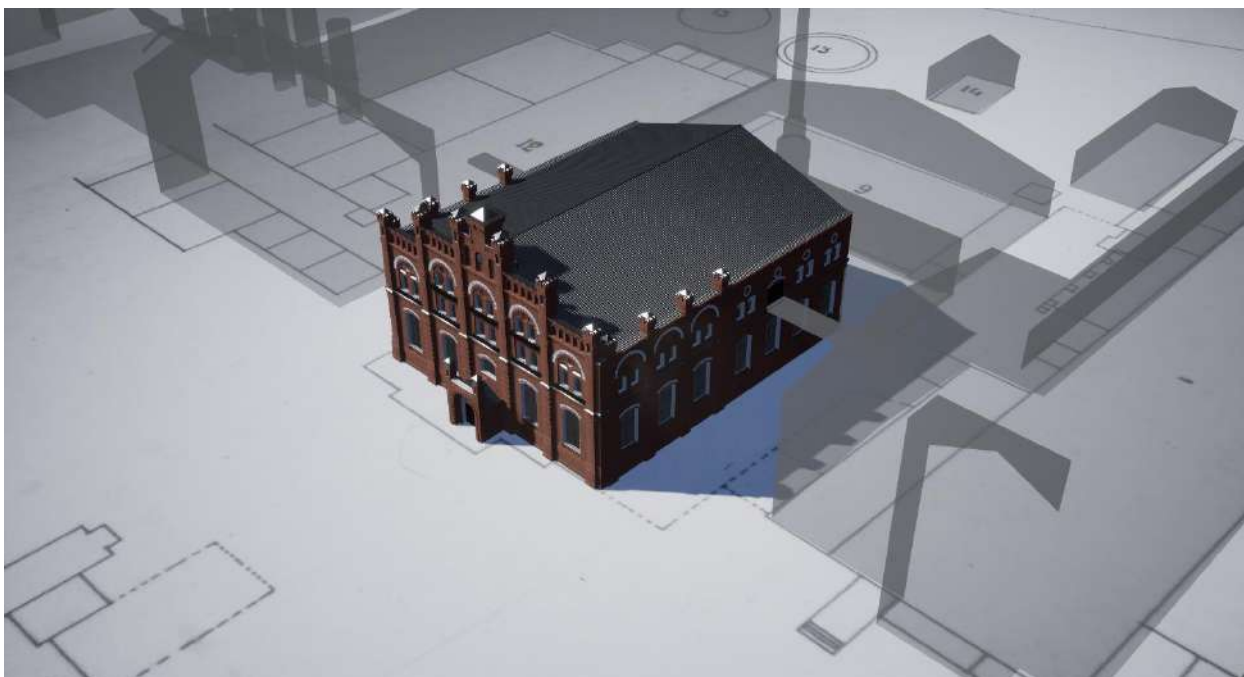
Виртуальная реконструкция корпуса Варни Трехгорного пивоваренного завода. Рендер в Unreal Engine 4. Вид сверху в ансамбле с другими корпусами, обозначенными полупрозрачными силуэтами.
